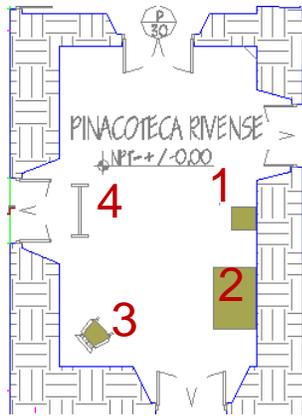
Ubicación en planta de los muebles en la Sala de Pinacoteca
